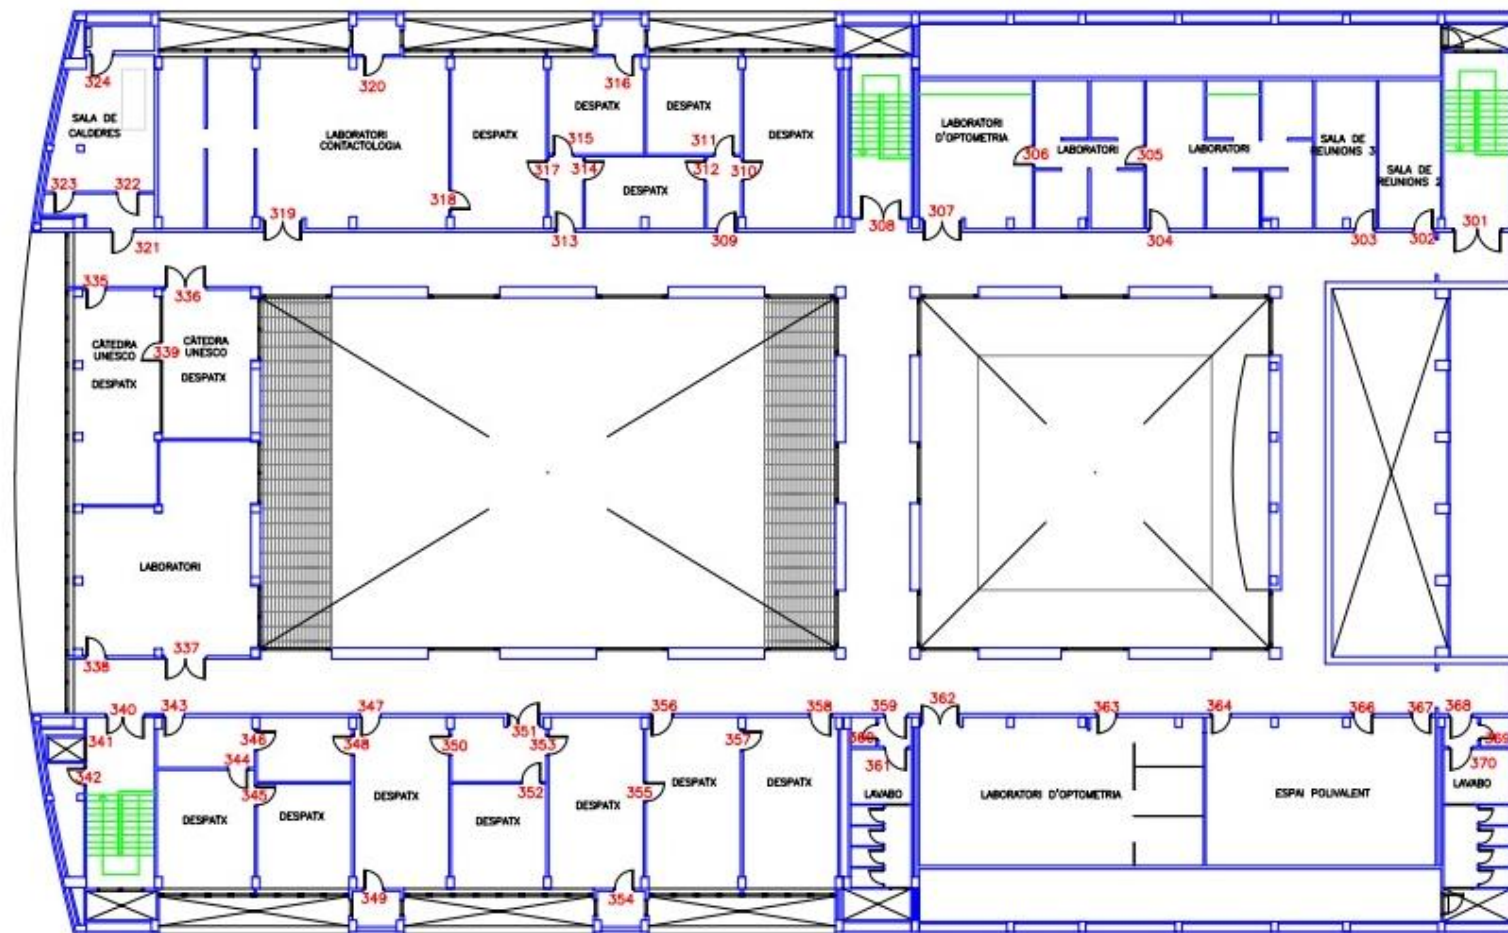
Pla de la Planta 3 de la FOOT^G.
